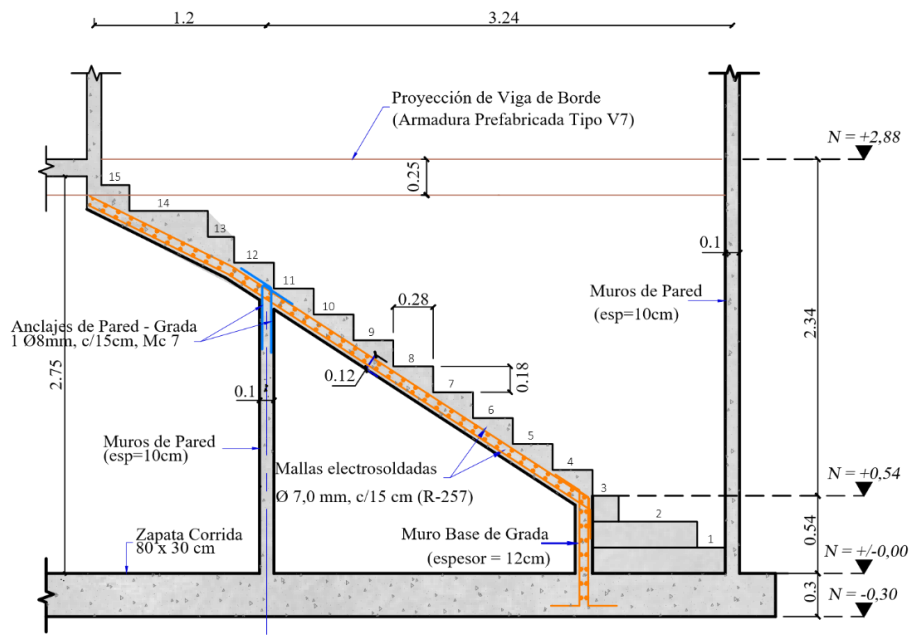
Sección Zapata y Sección Pared 31 Viviendas
